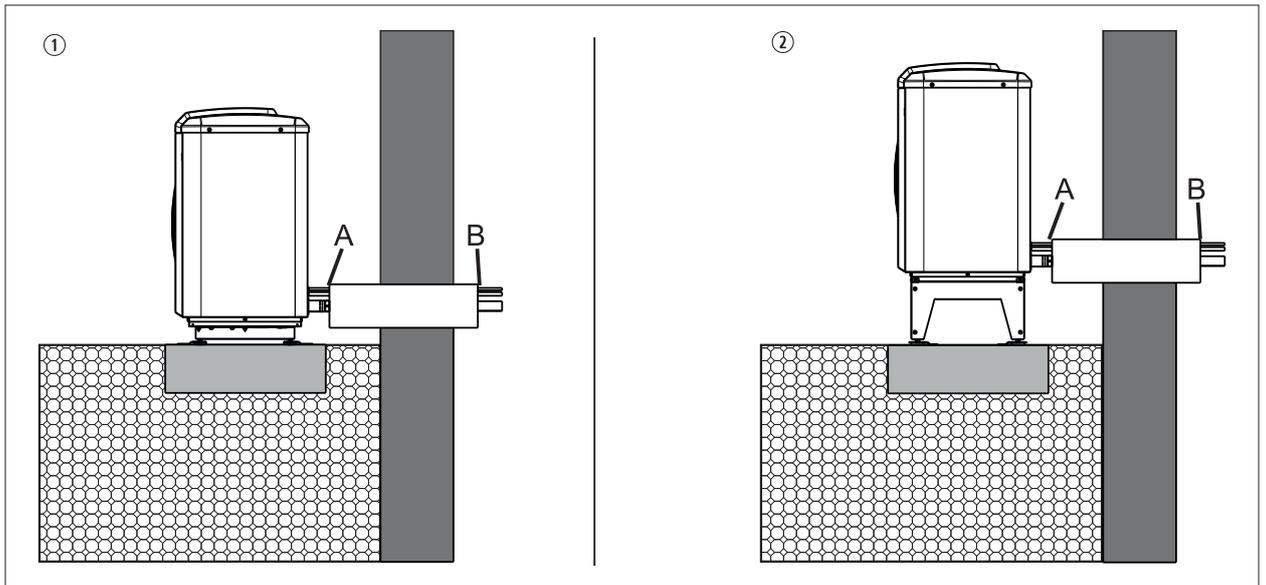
Canalizzazione a muro al di sopra del terreno
